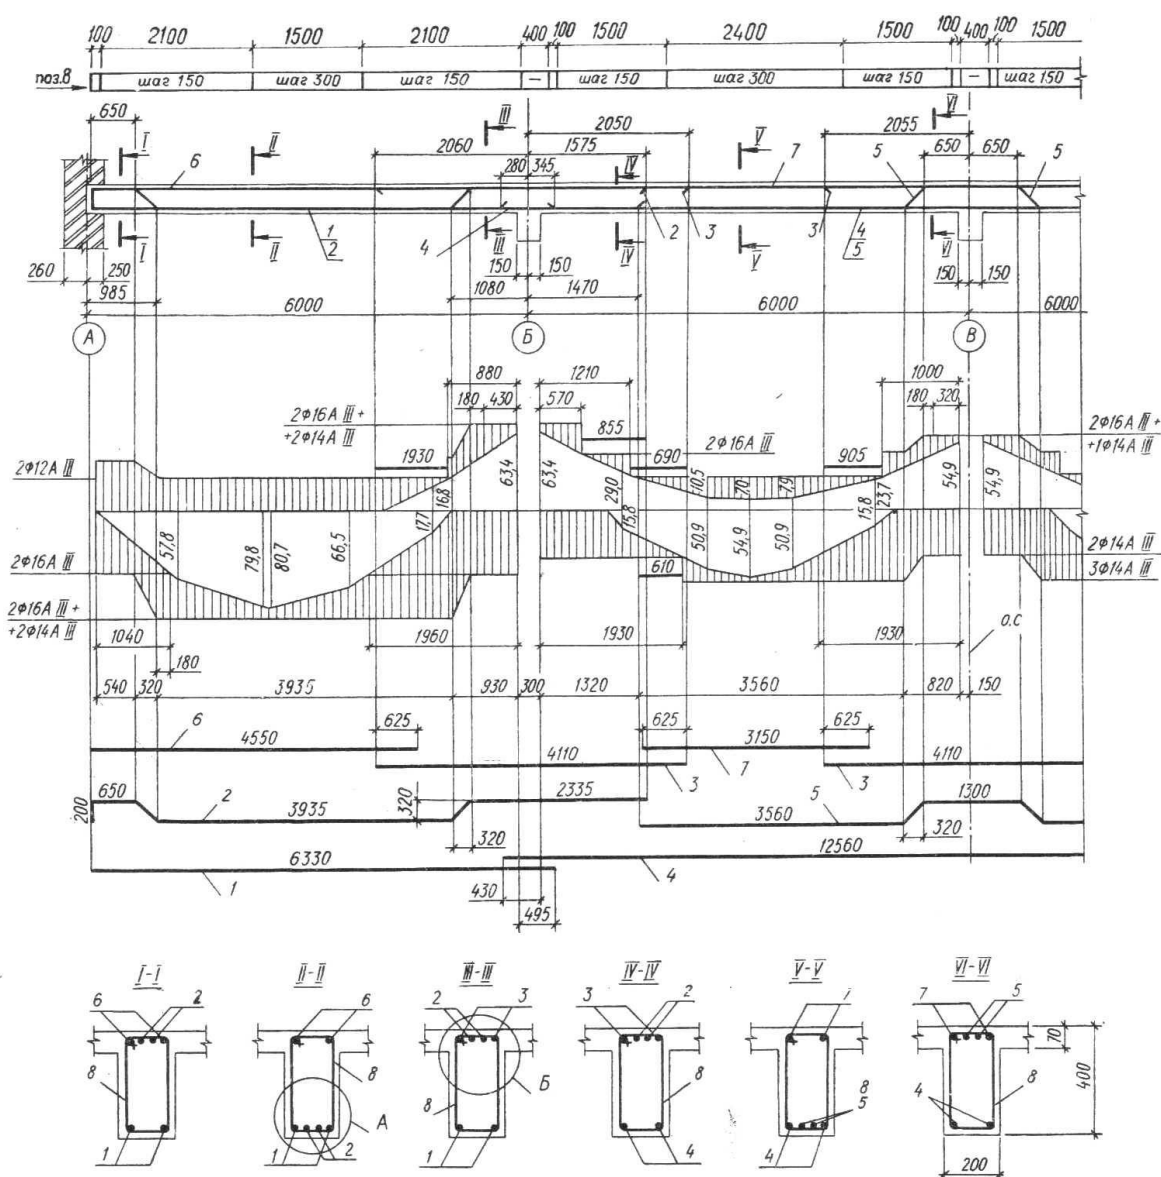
Схема армування другорядної балки монолітного ребристого перекриття
